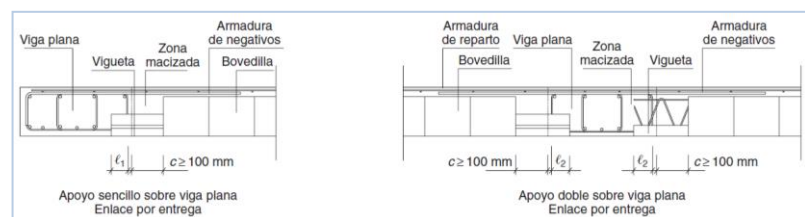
y 28. Apoyo sobre viga plana. Enlace por entrega
